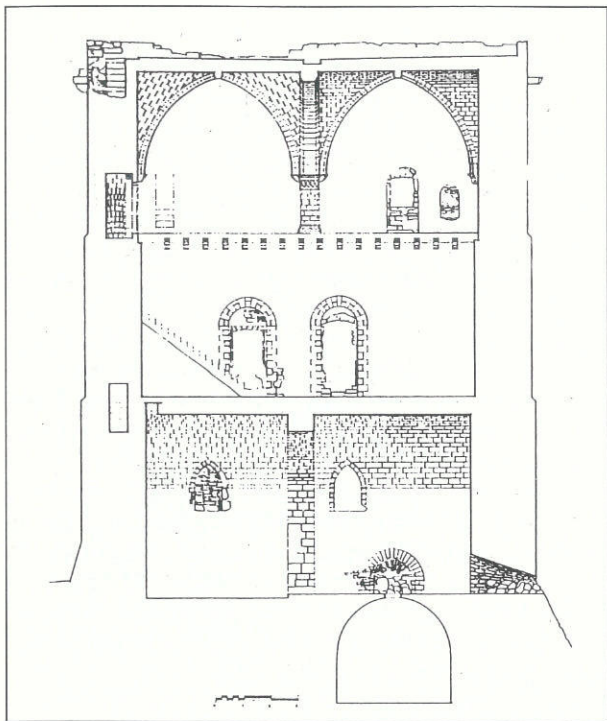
Sezione longitudinale (da SPATRISANO).
